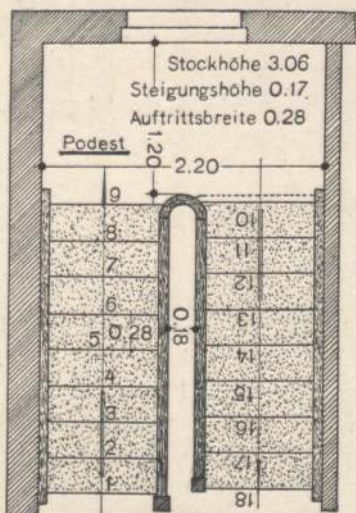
Grundriß zu einer Podesttreppe mit Übergangsgeländerkrümmling.
